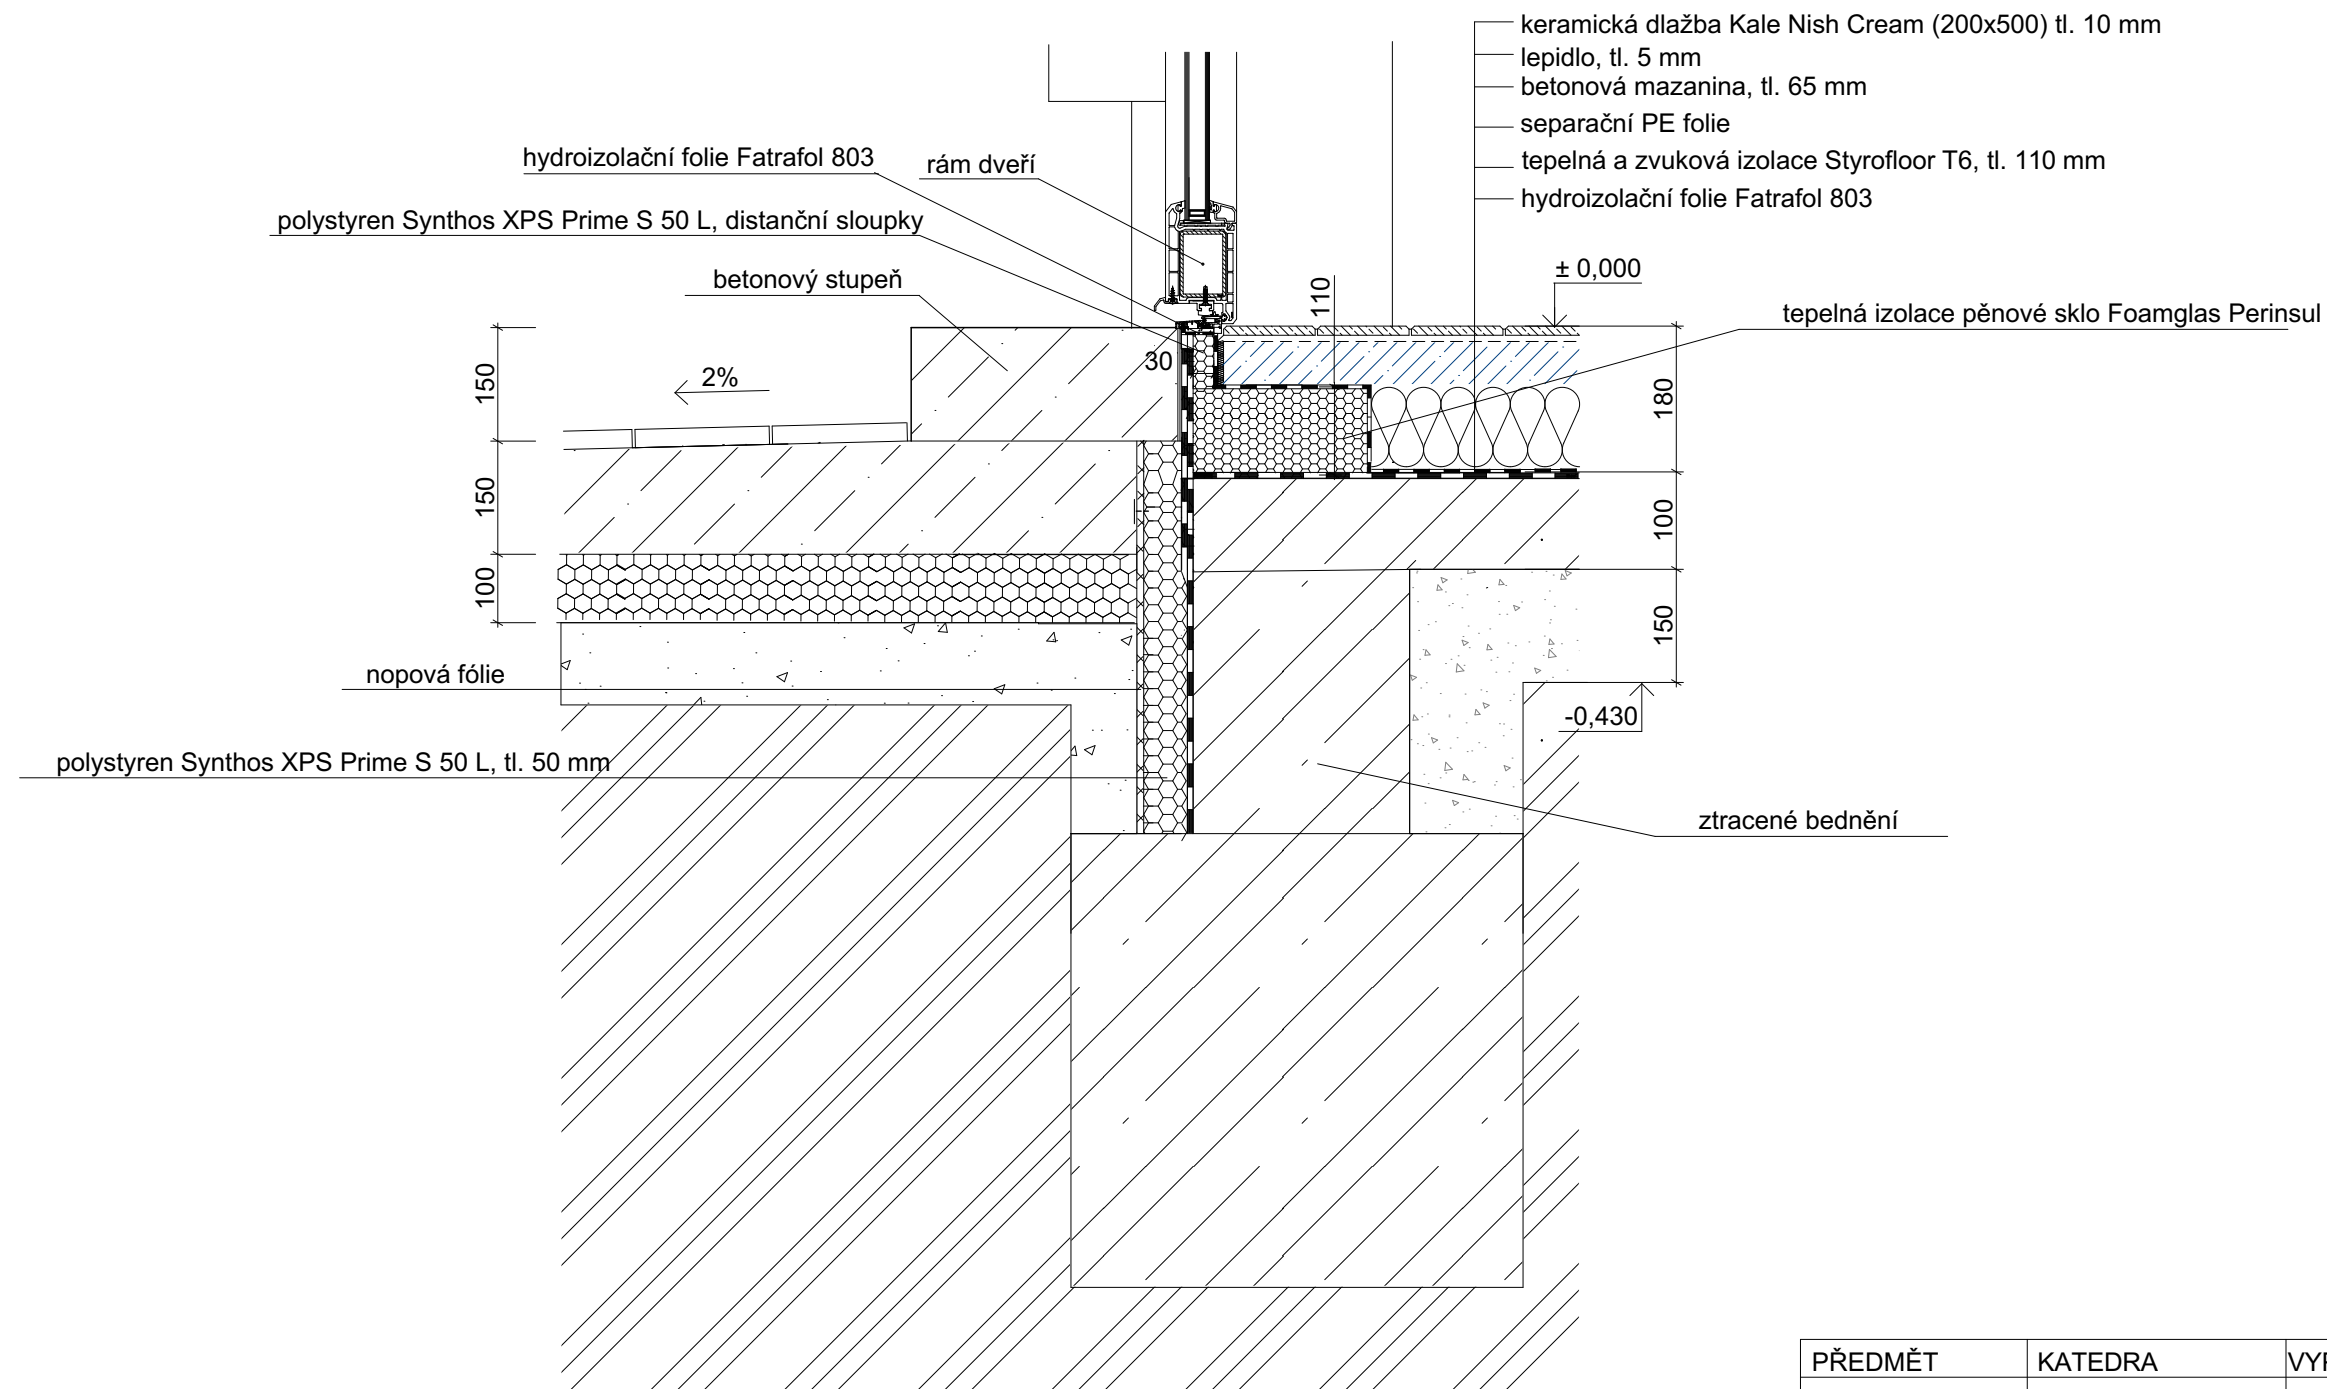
# DETAIL C - DETAIL PŘEDSAZENÉ ČÁSTI OBJEKTU
